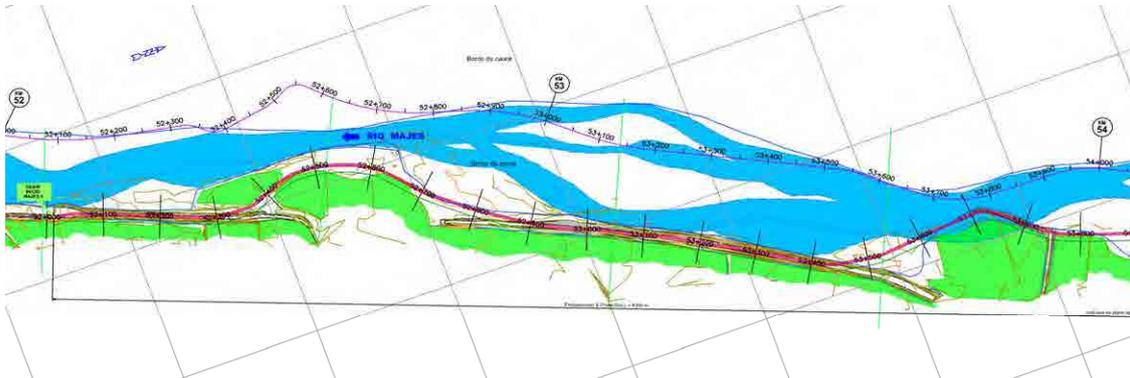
Planta de instalaciones Majes-5 (2)
